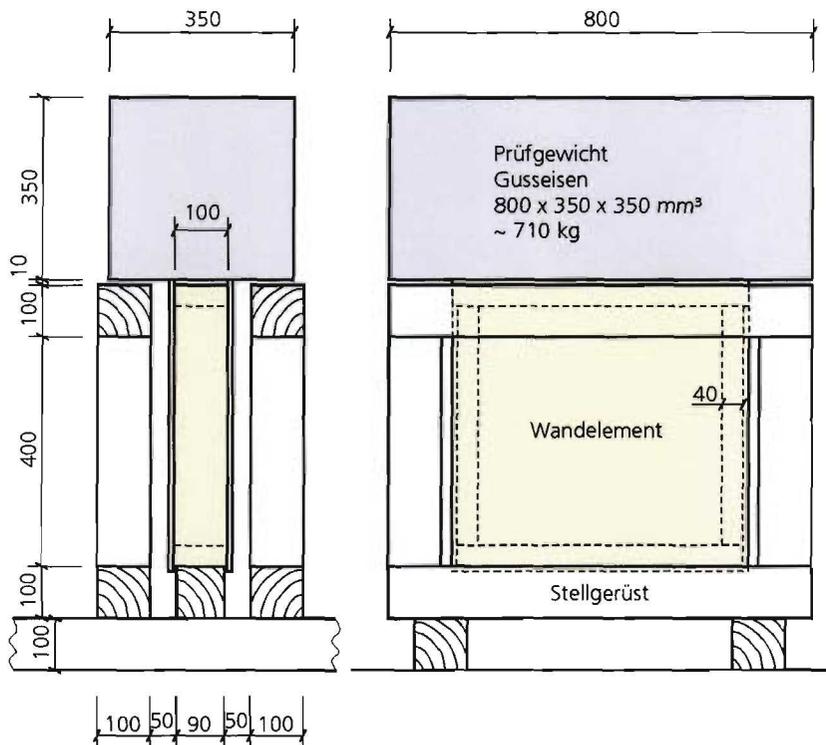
Wandelement mit Stellgerüst und Prüfgewicht
